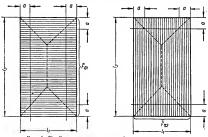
75. Схема укладки стержней арматуры в плите.
